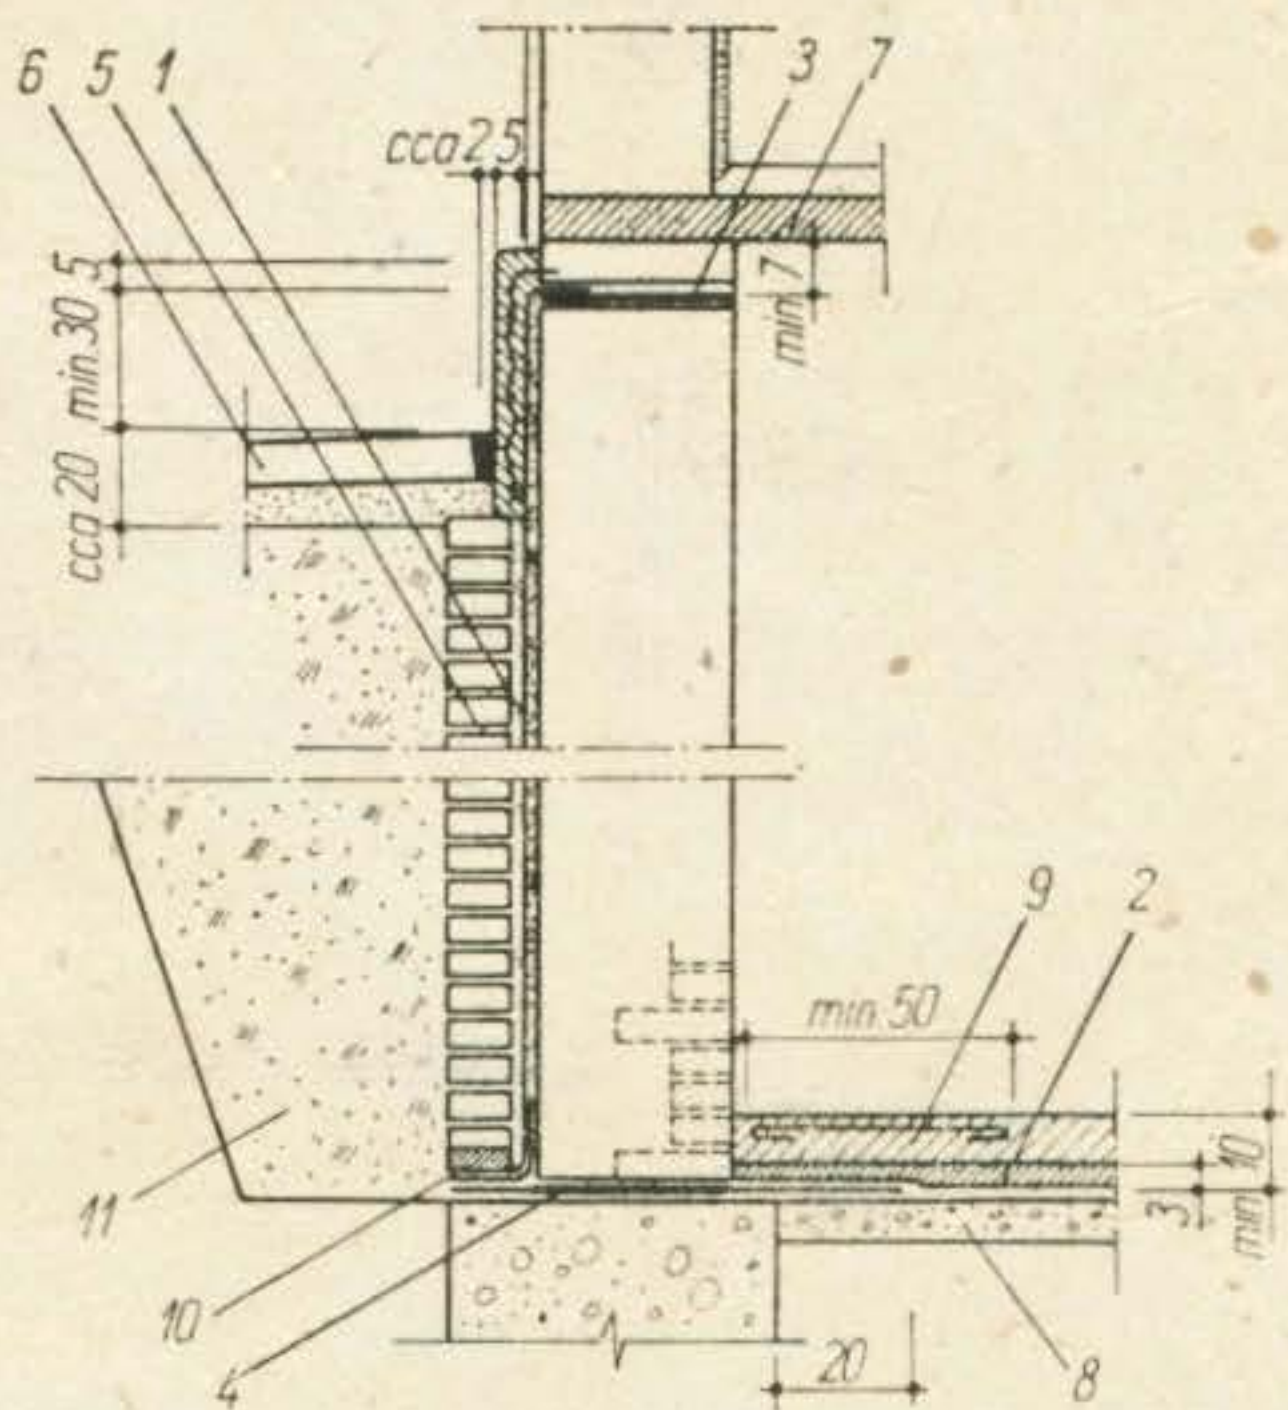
Hidroizolarea verticală a pereților la construcții cu subsol:
